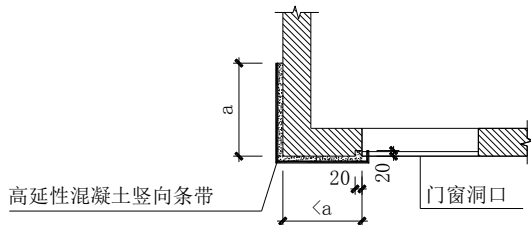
高延性混凝土竖向条带设置平面示意图
